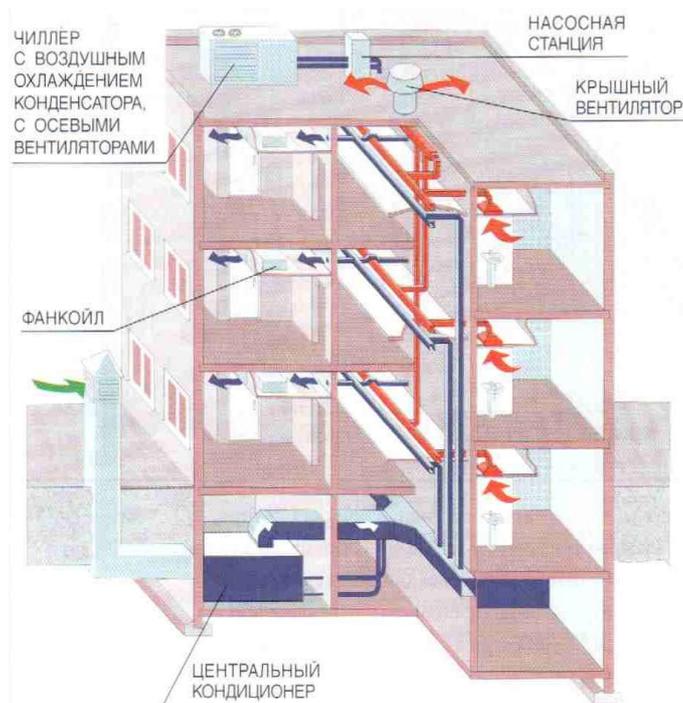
Схема системы кондиционирования и вентиляции общественного здания
